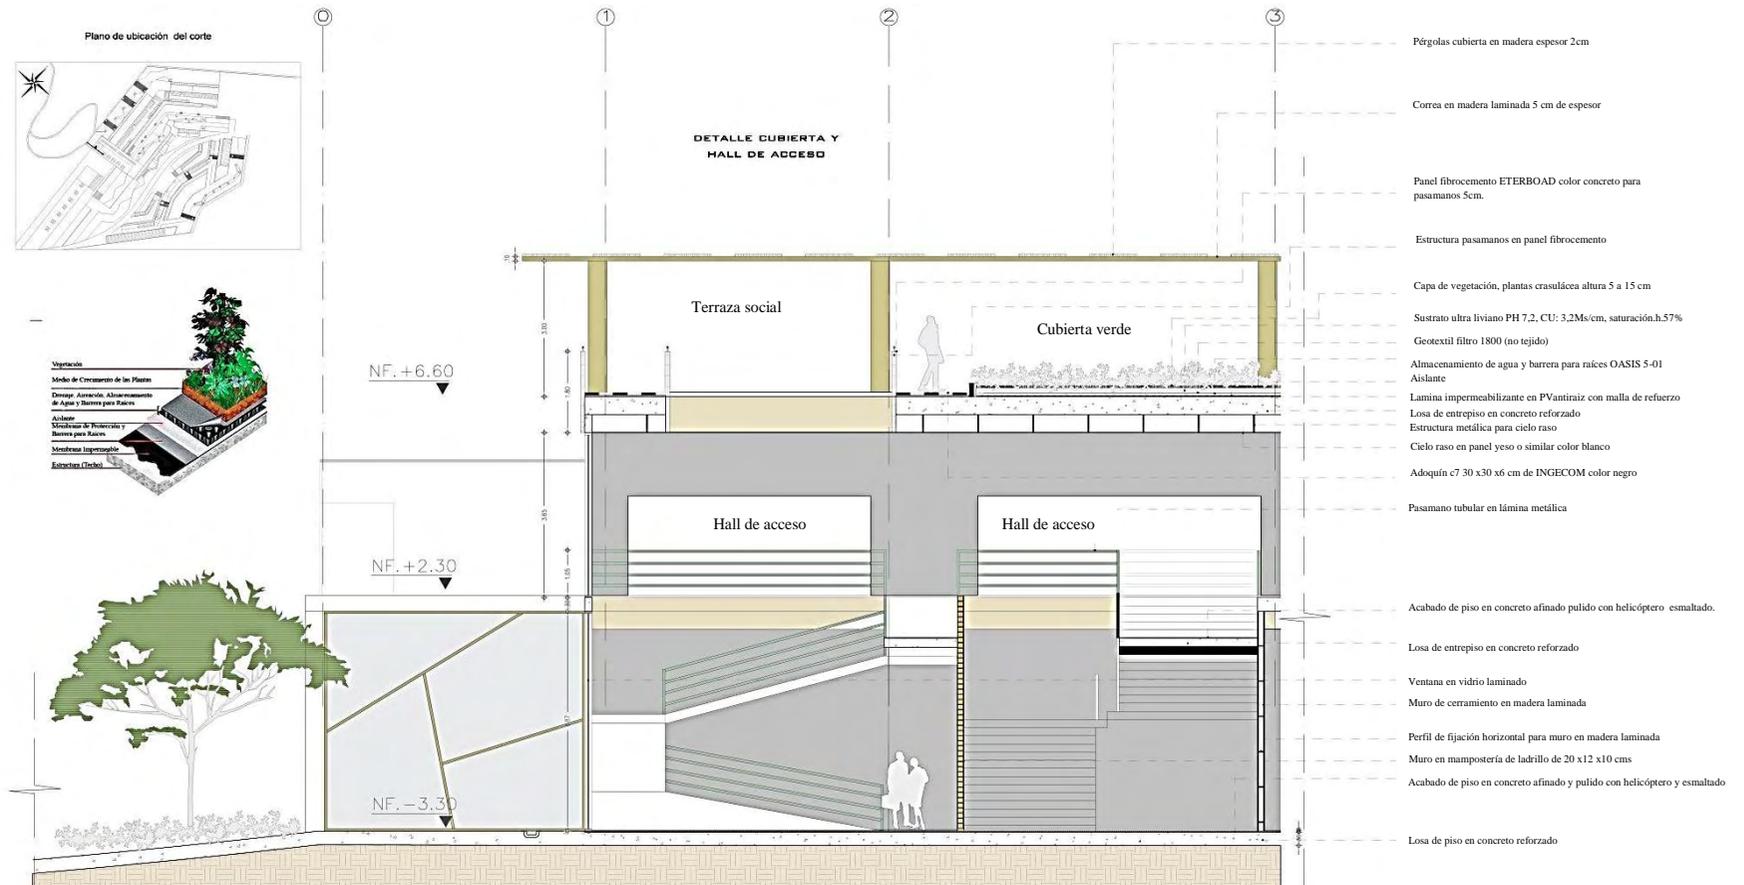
//imagen plano detalles constructivos centro gastronómico: elaboración propia
